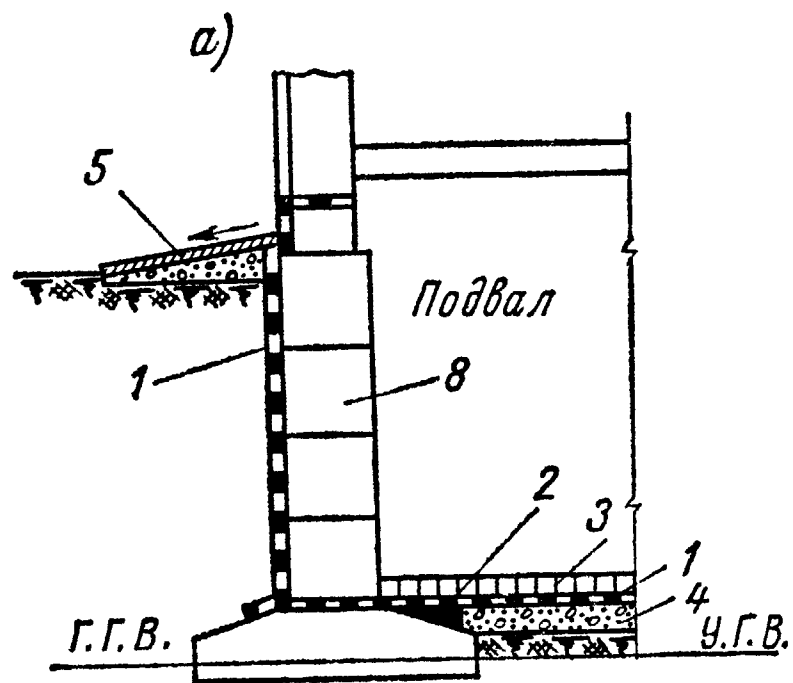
Сопряжение гидроизоляции пола подвала со стенами здания:
